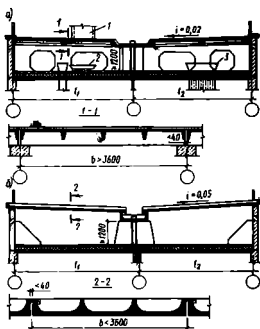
Чердачные сборные железобетонные крышки:
